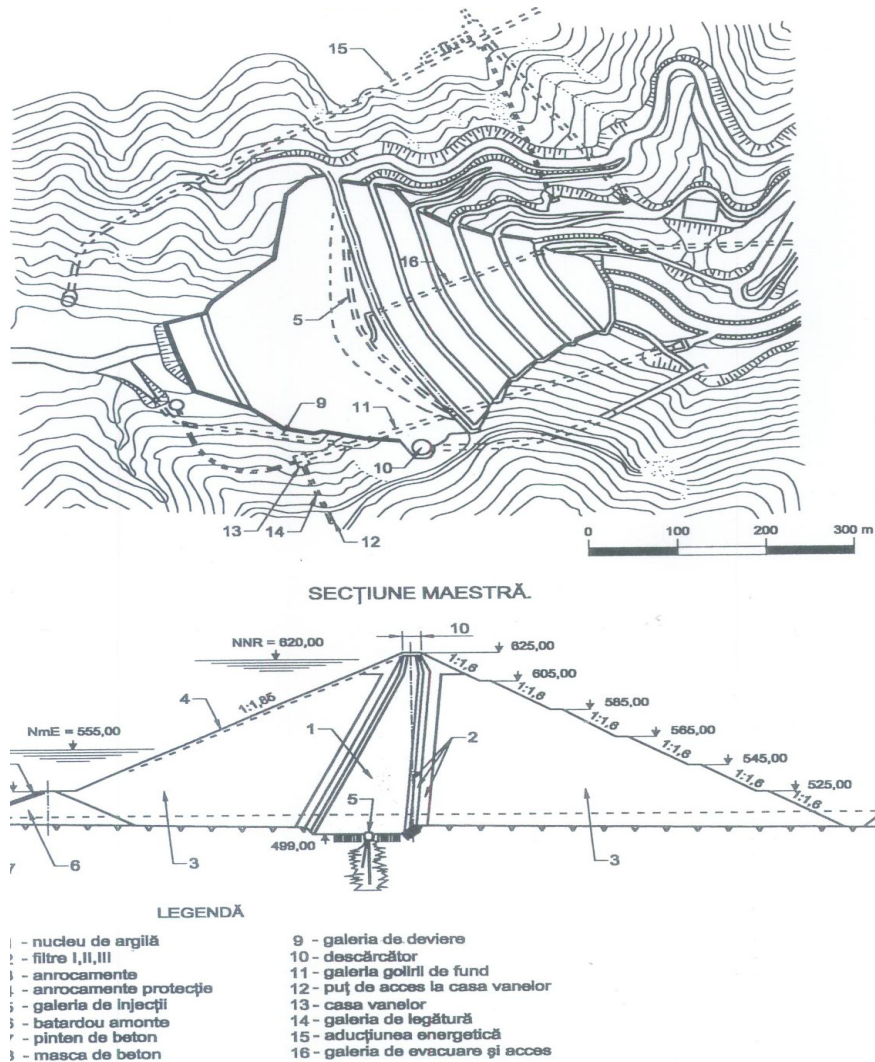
Barajul Poiana Mărului – vedere în plan
